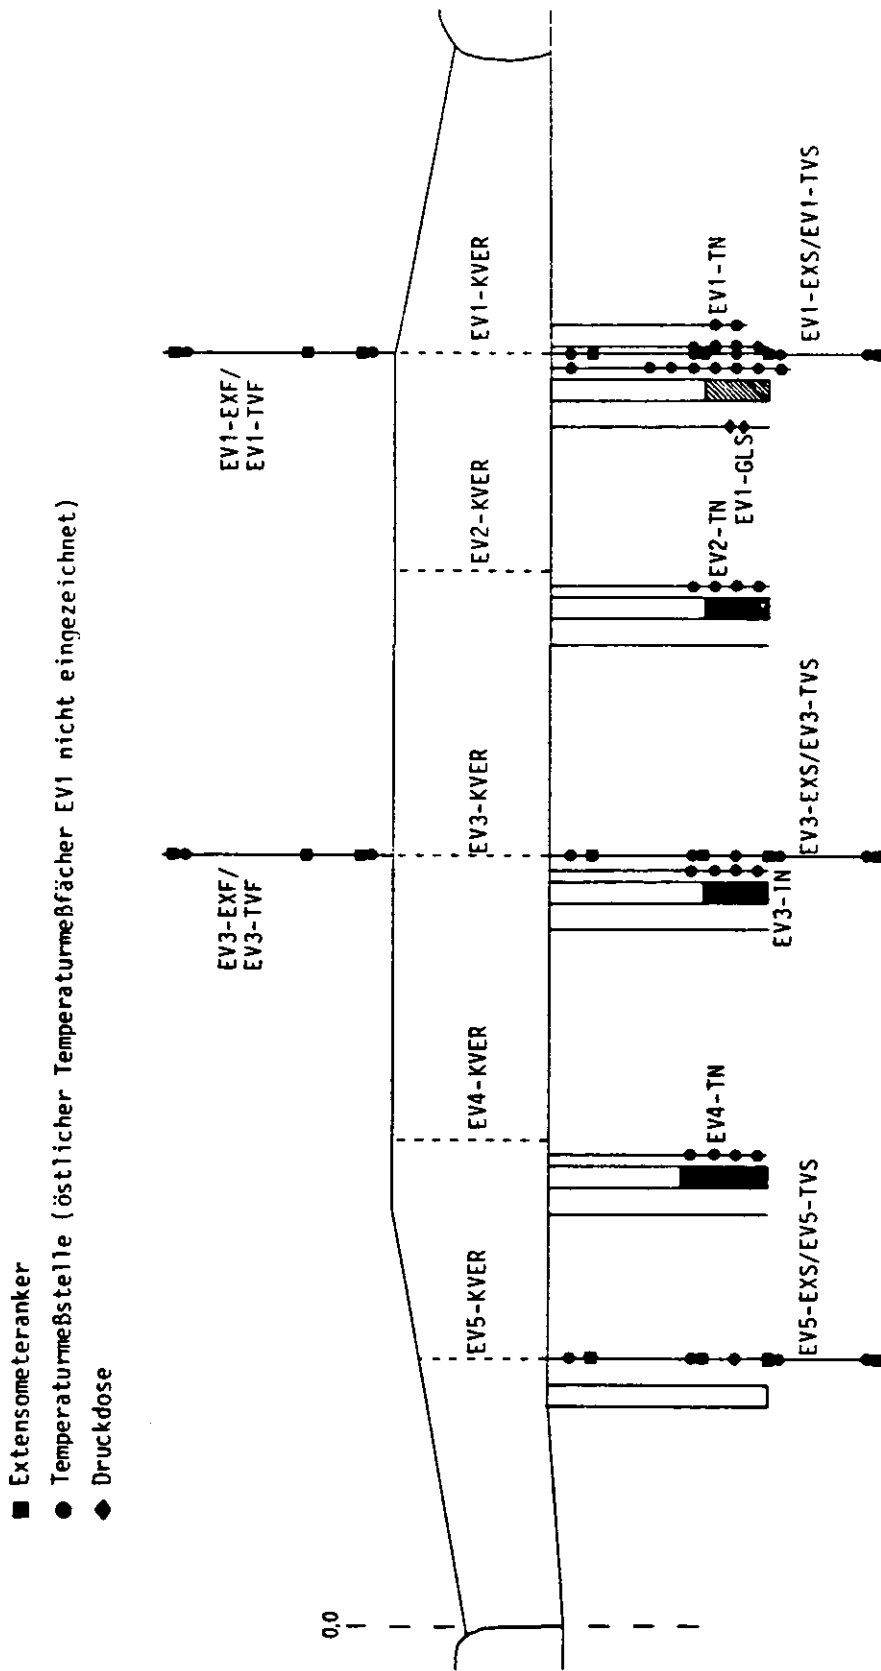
Längsschnitt der MAN-EV-Strecke mit geplanter geotechnischer Instrumentierung
